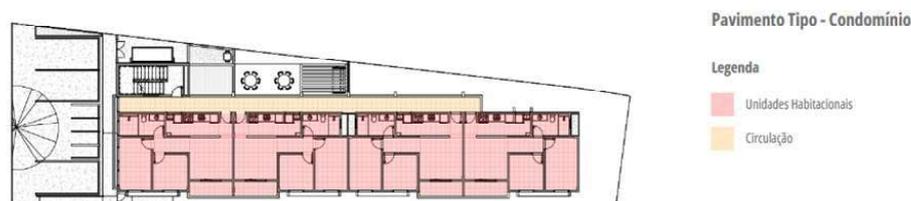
Planta Baixa Pavimento Tipo Condomínio com setorização
